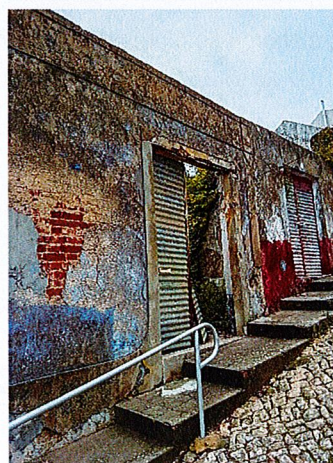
Vista sobre o muro confinante com a Rua de Simões
